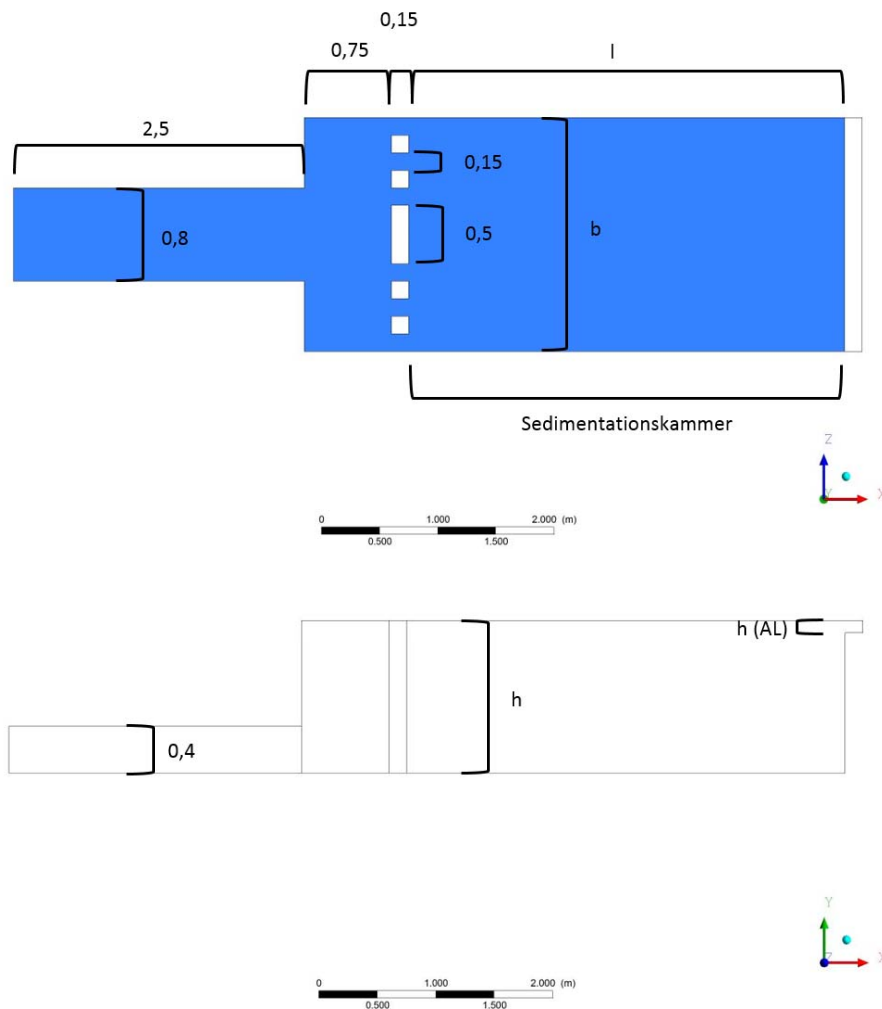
Gewählte Grundform des optimierten Beckens: oben: Draufsicht; unten: Längsschnitt
